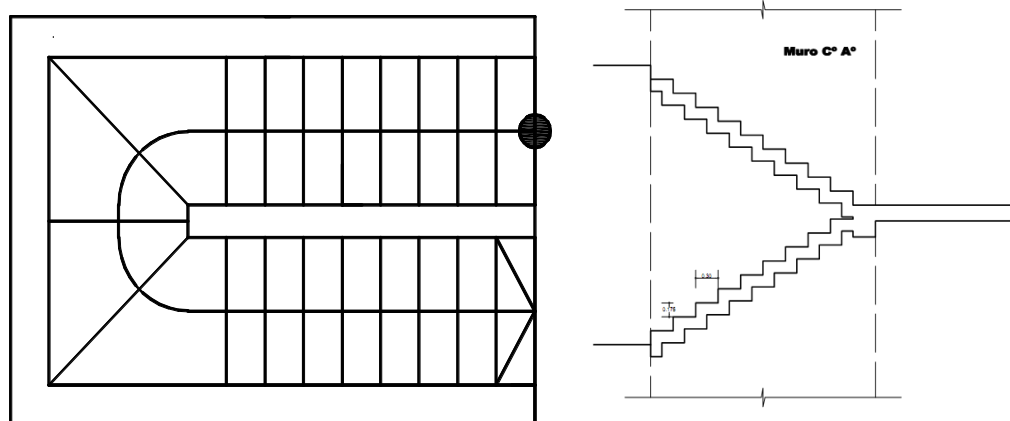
3: DETALLE DE ESCALERA
